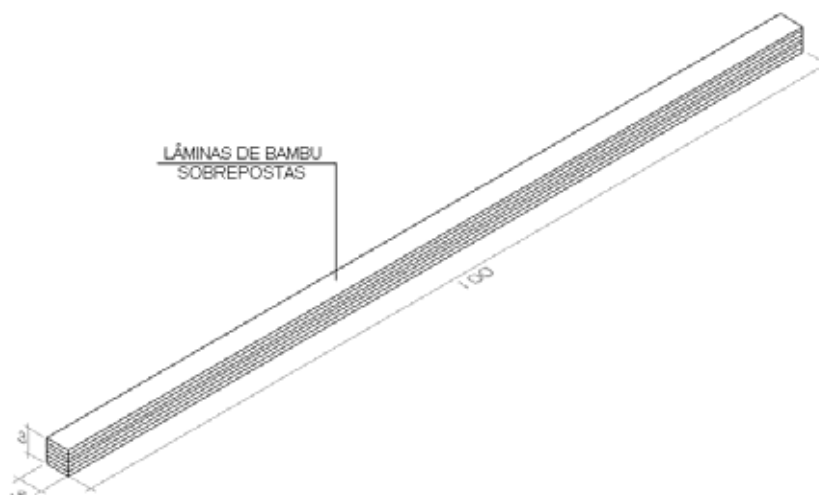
Desenho esquemático do perfil modular básico do elemento pré-fabricado (em cm).
